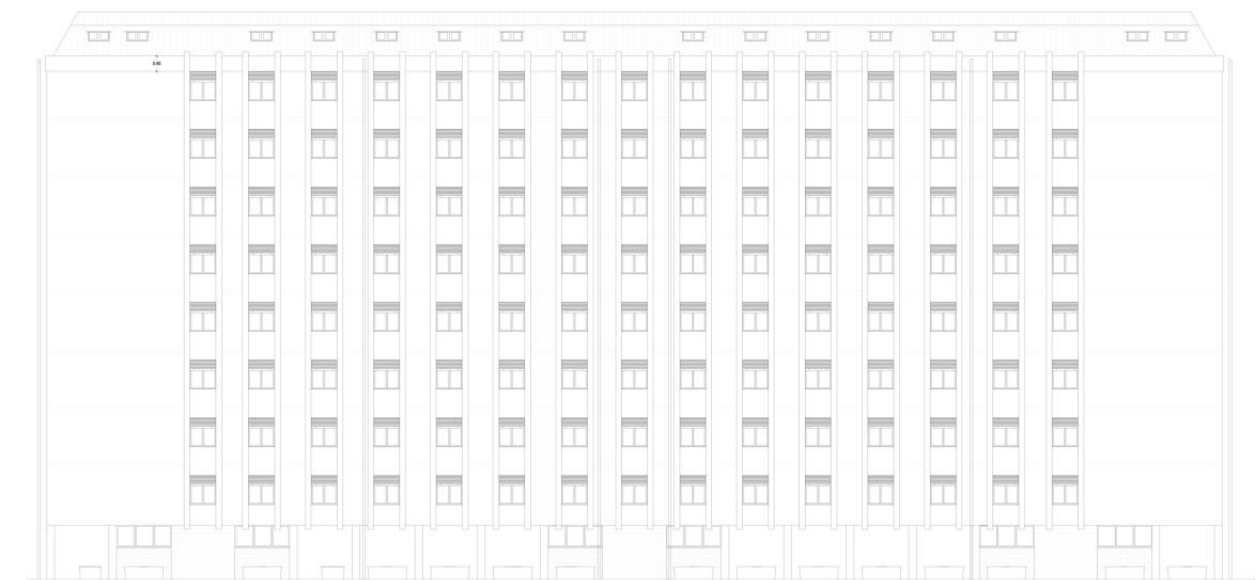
Prospetto Frontale lato Via Accademia del Cimento
